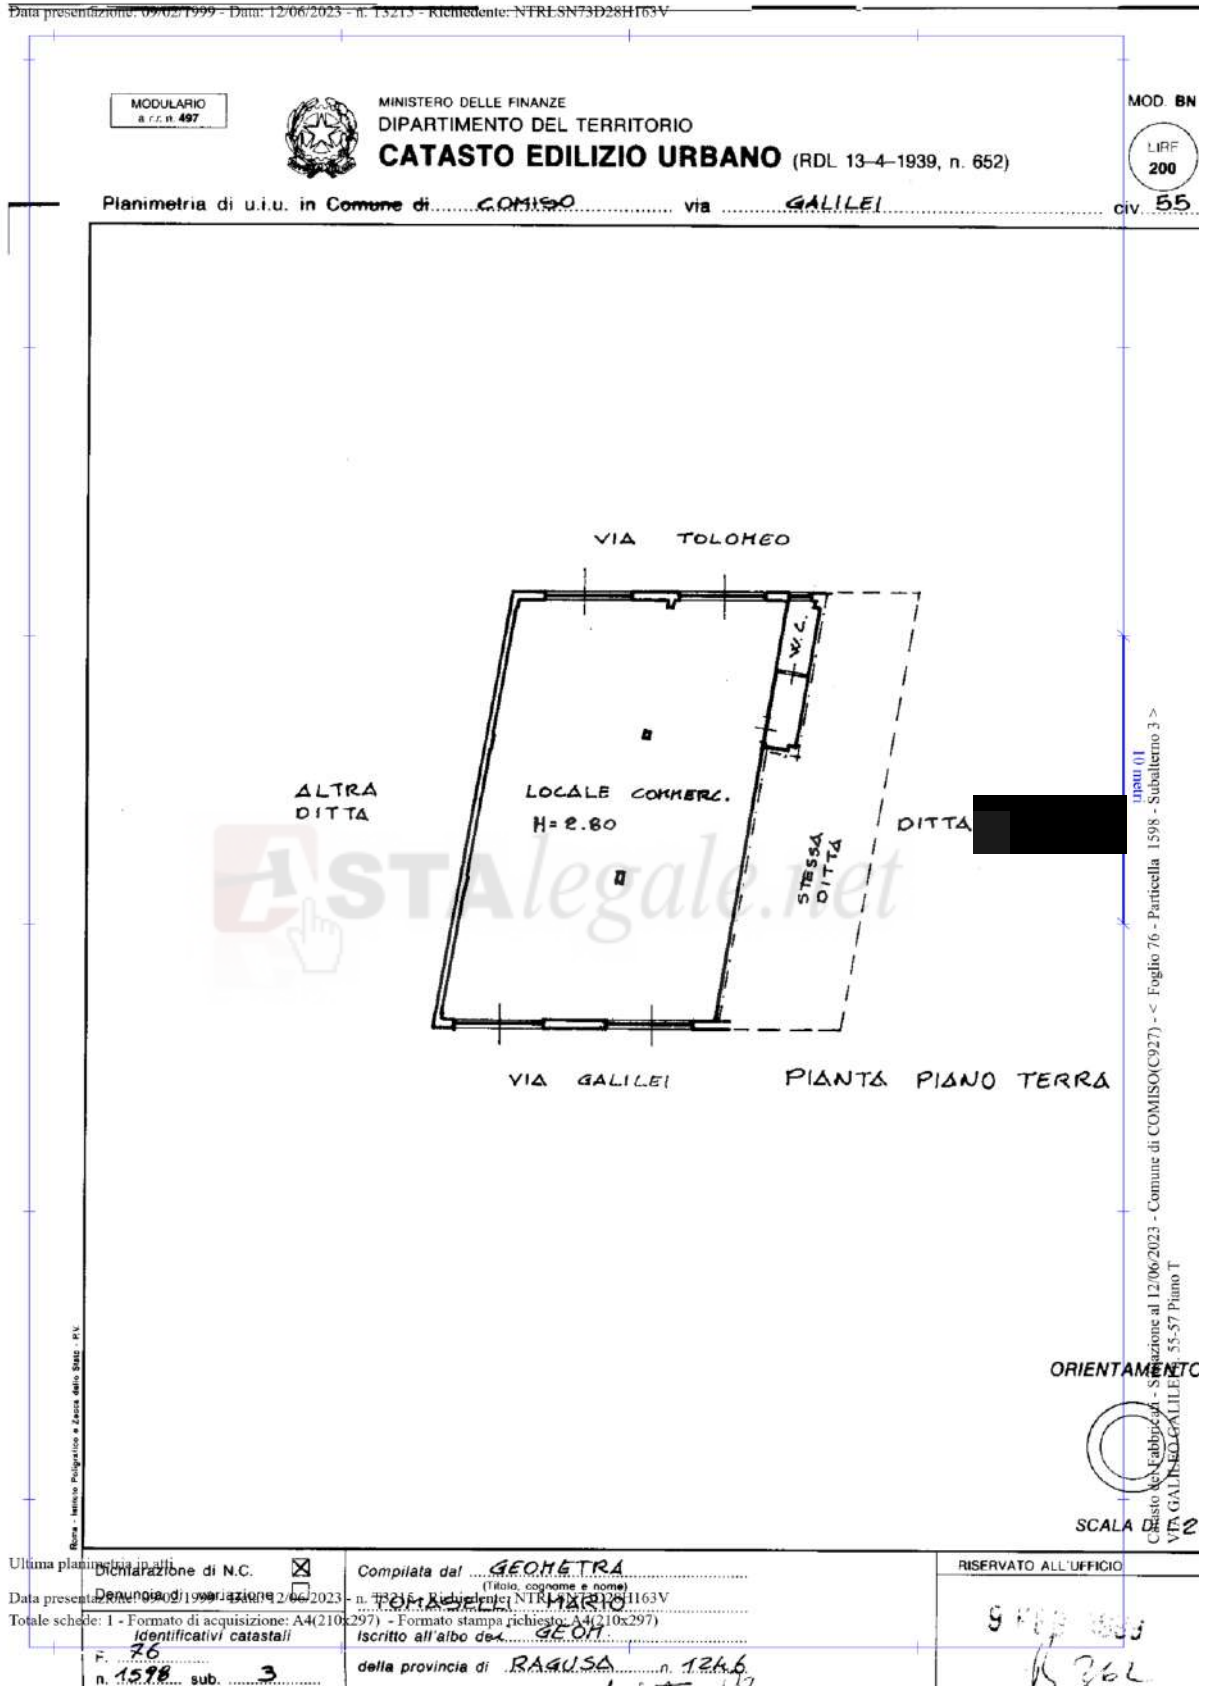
Estratto Planimetria Catastale Foglio n°76, Particella n°1598, Sub 3 – PIANO TERRA
